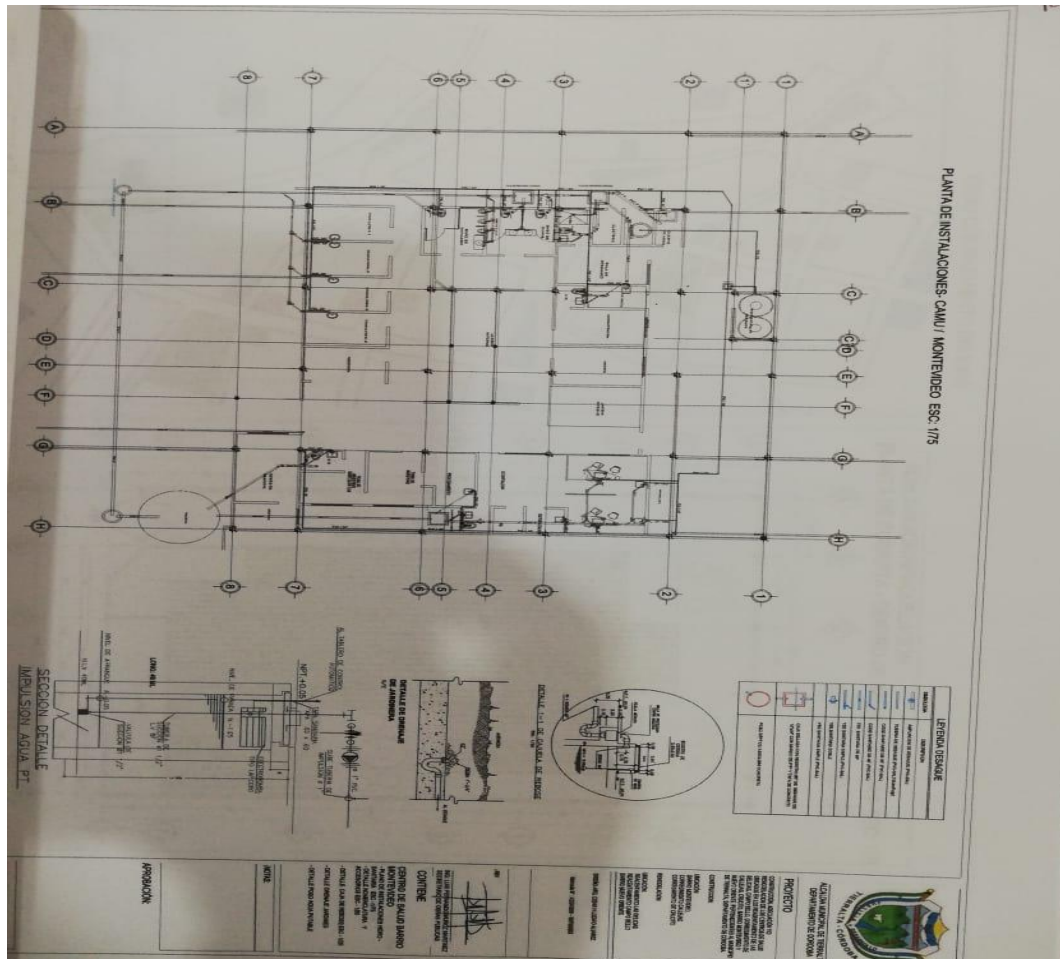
En la figura se puede evidenciar la aprobación de los planos modificados por el practicante, los cuales serán utilizados para una adición al concreto. Fuente: Practicante (2019)
